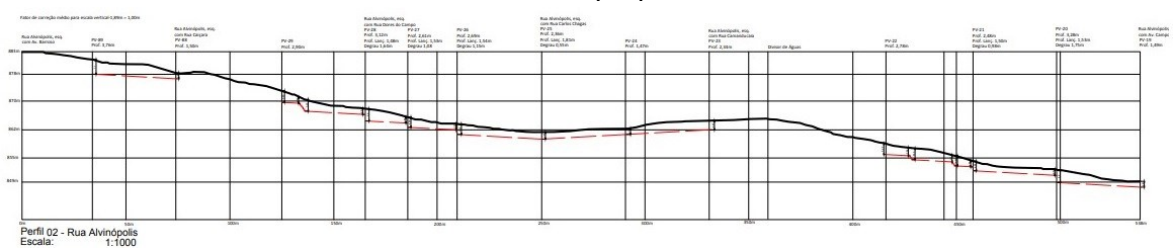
Perfil longitudinal da rua Alvinópolis
